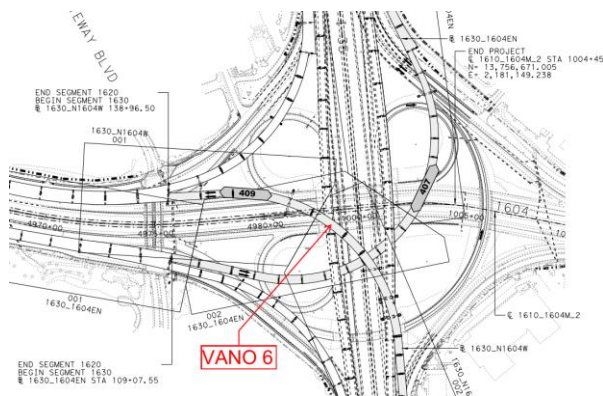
Situación del vano 6 del puente 409 en el intercambiador entre las calzadas elevadas de la I-35 y la autopista Loop 1604.
